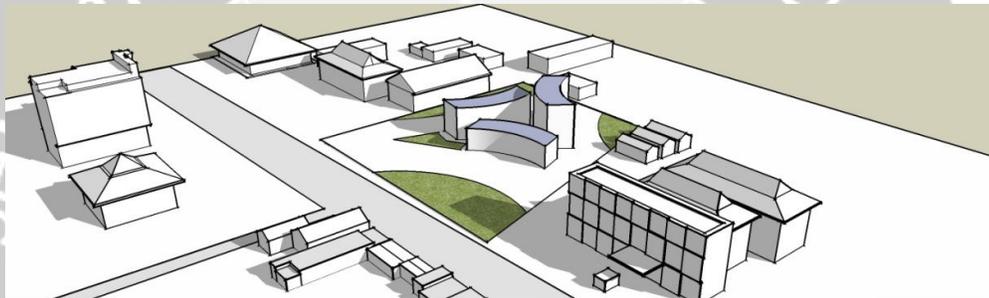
Penerapan massa bangunan ke dalam tapak
